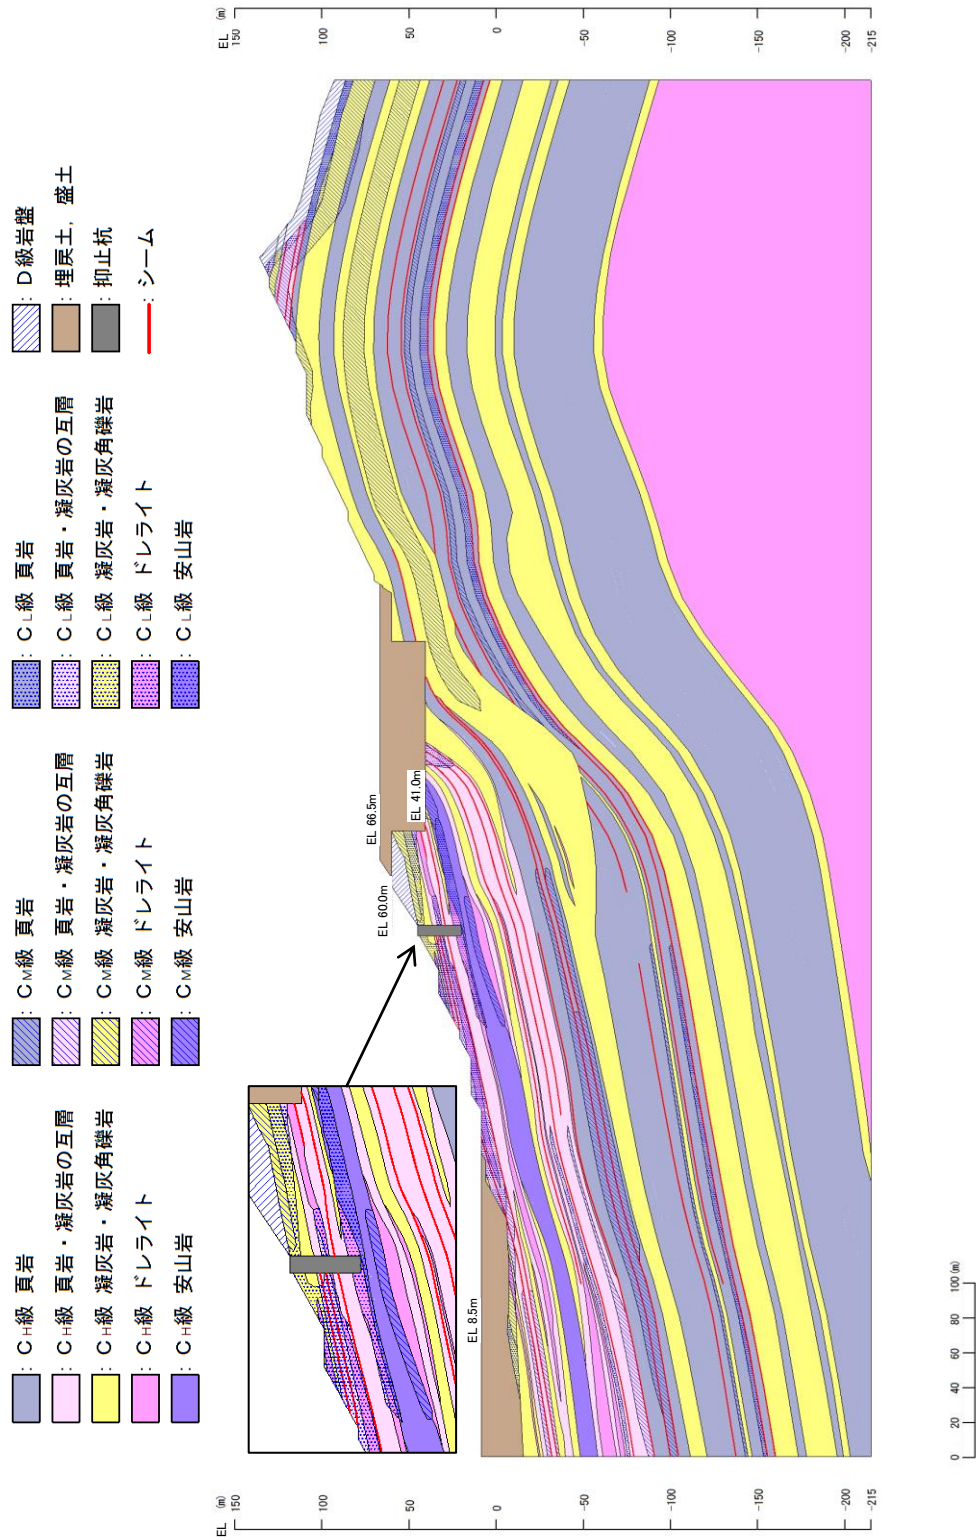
②-②' 断面 解析用岩盤分類図
